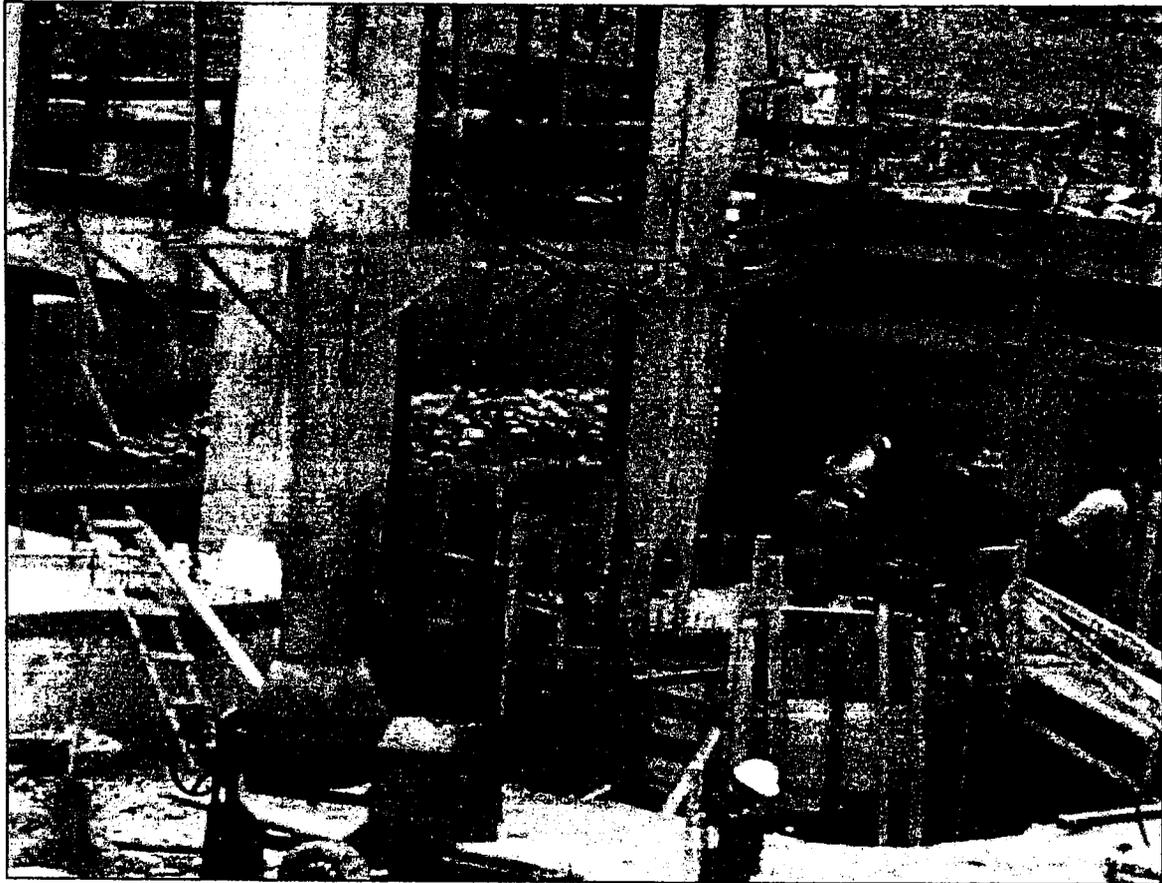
ENCOFRADO DE MURO DE CONCRETO EN CISTERNA DE AGUA SALADA
